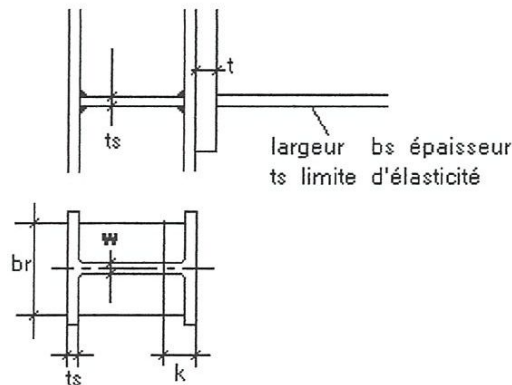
Raidissage horizontal de l'âme du poteau.
